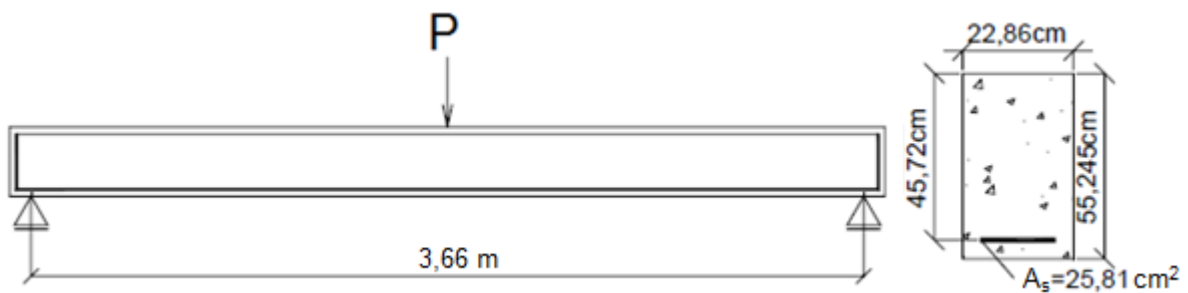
Armadura e geometria da viga biapoiada - Bresler e Scordelis (1963).
